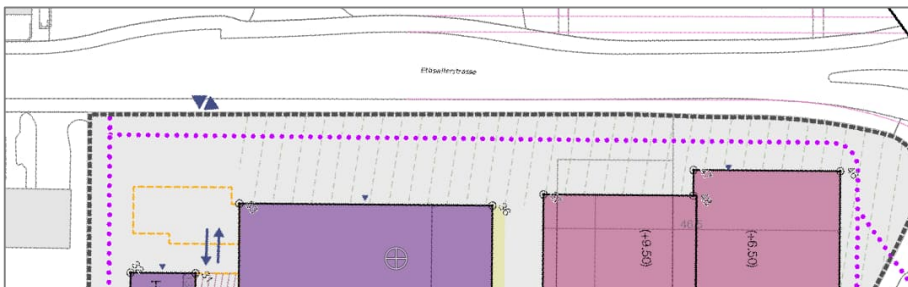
Ausschnitt Bebauungsplan (gedreht), Aufwertung Strassenraum an der Ettiswilerstrasse
